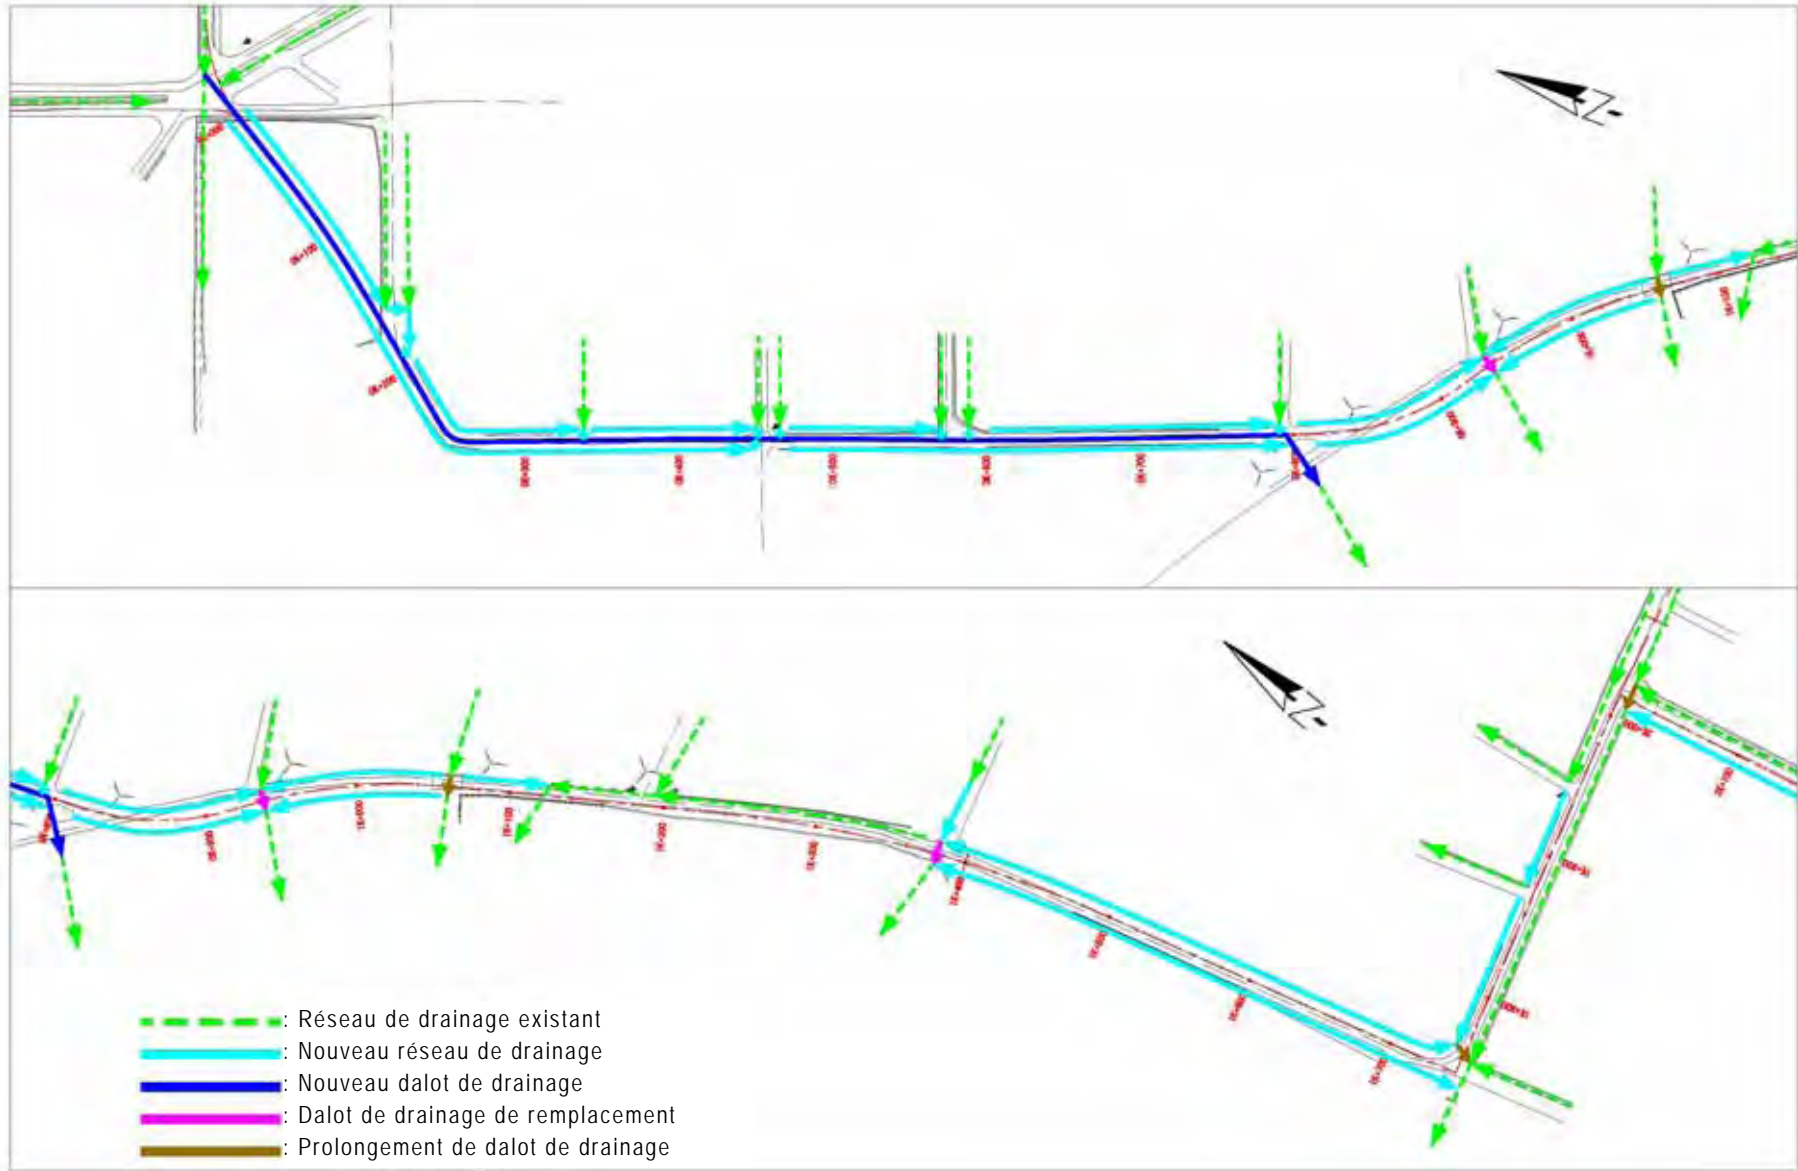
(1) : Plan de réseau de drainage des routes de projet (1/3)
